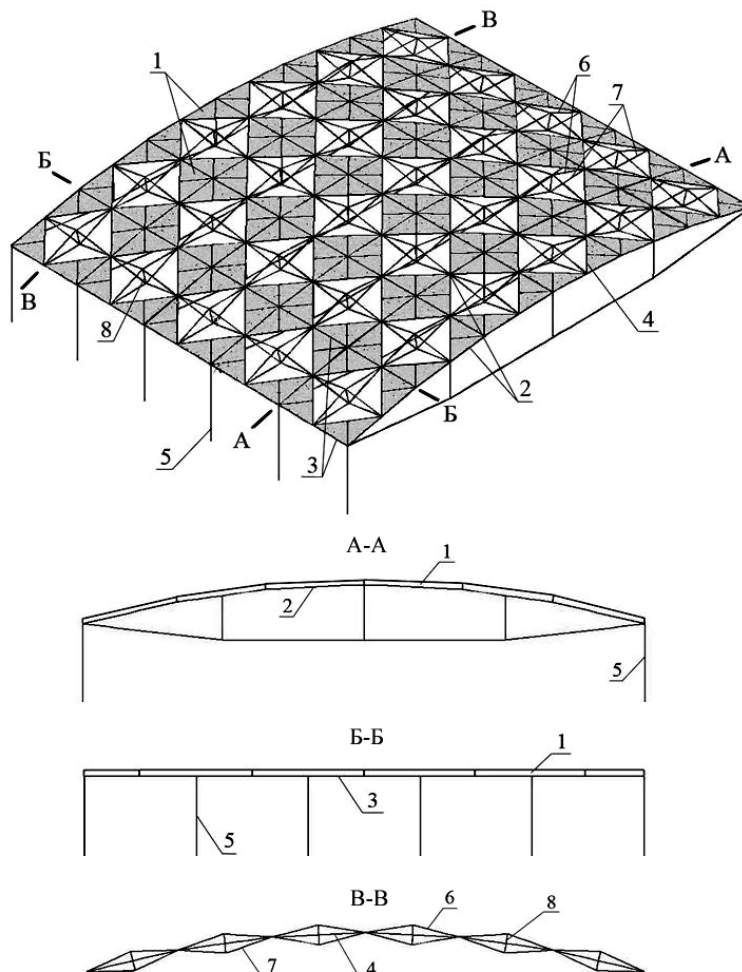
Общий вид сборного железобетонного сводчатого покрытия.
